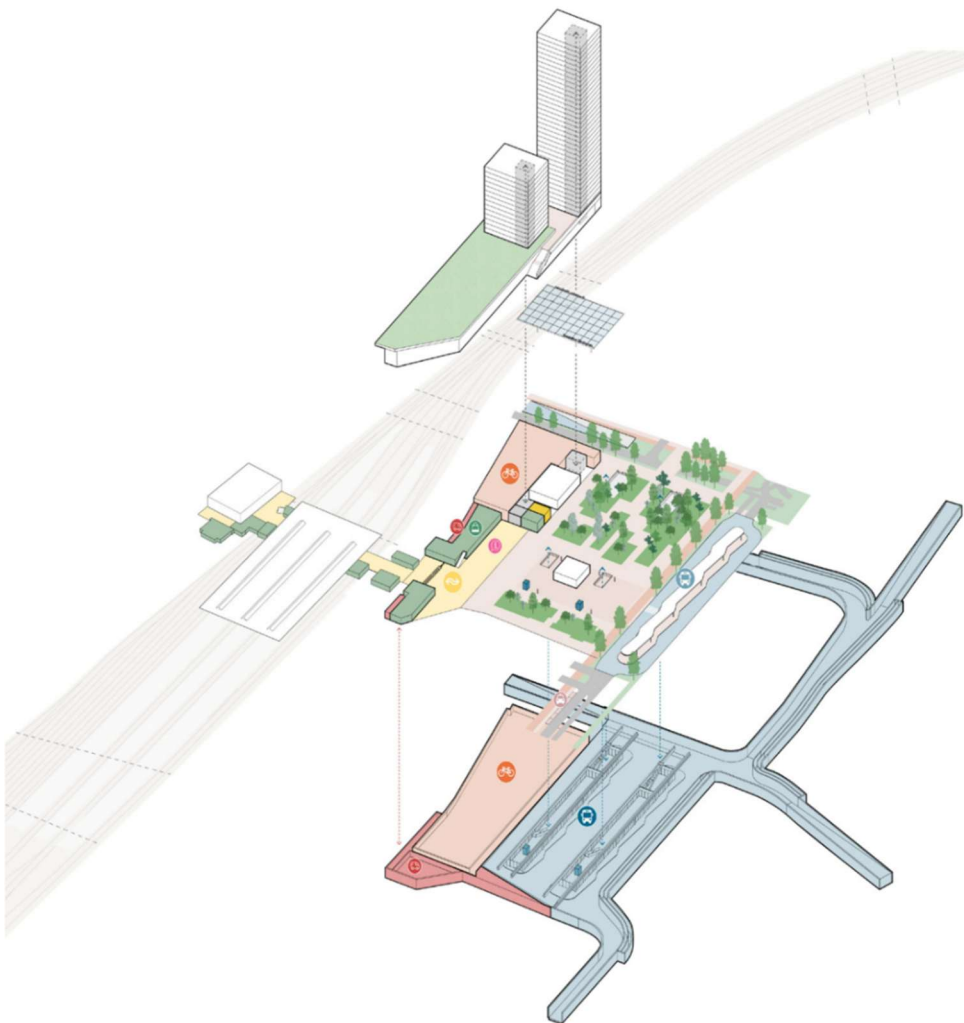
Alternatief B – busstation evenwijdig aan spoor en fietsenstalling grenzend aan spoor
